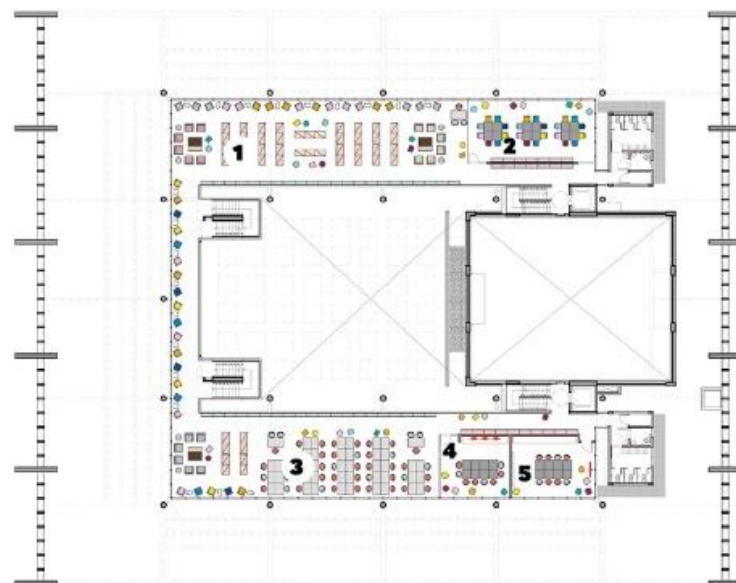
Planta baixa 1 pavimento Biblioteca Villa Lobos. Fonte: Archdaily (2019a).
